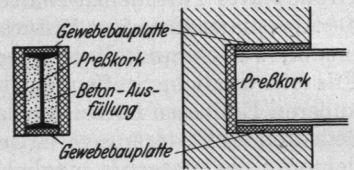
Isolierung eines Trägers gegen das Mauerwerk.
